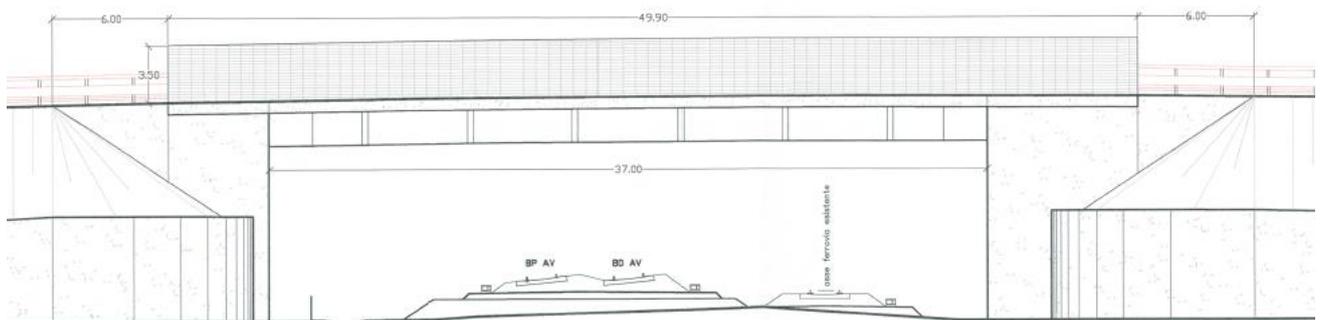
Sezione longitudinale cavalcaferrovia IV15 nel progetto approvato
